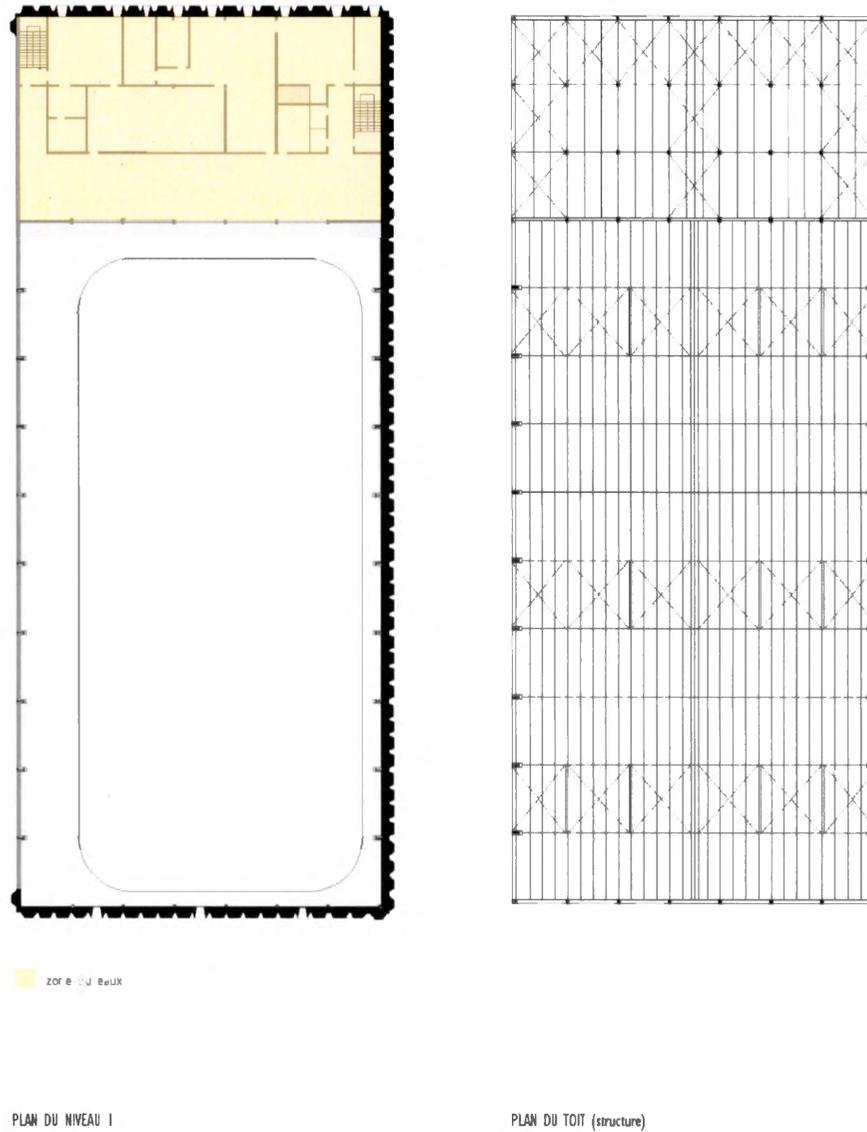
Plans et annotations du Complexe Arnaitok, Iqaluit (2018). Dessiné par Fayza Mazouz d'après relevés sur place et étude d'archives.
